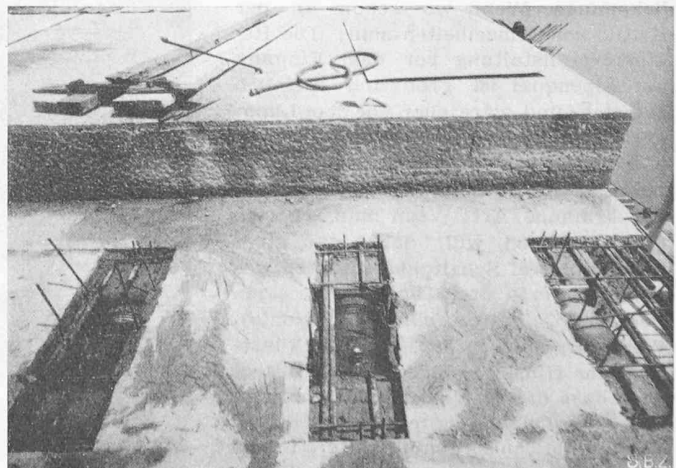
Wie Bild 4, jedoch nach dem Betonieren
